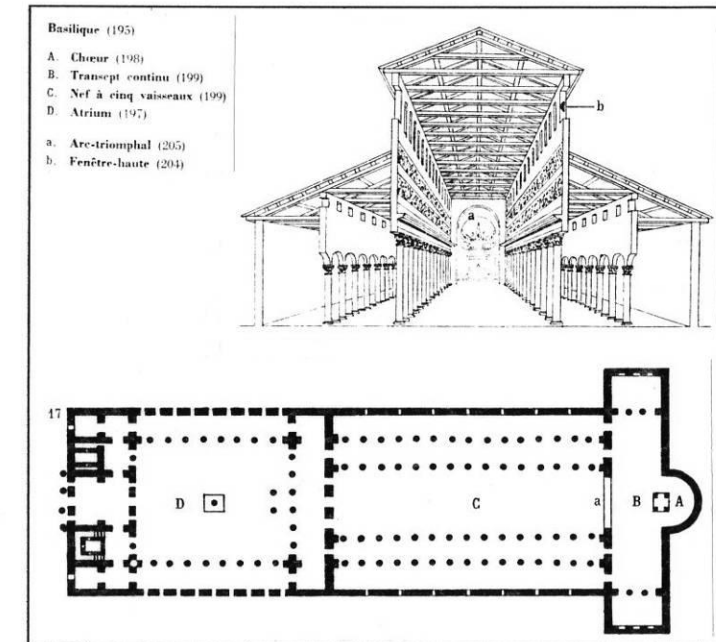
Plan général d'une basilique et coupe transversale (dictionnaire d'architecture)
